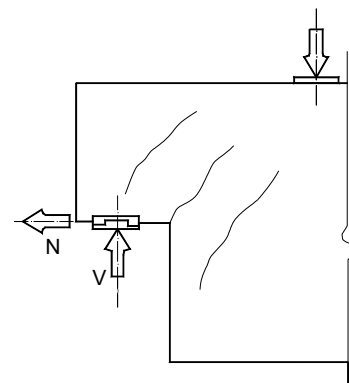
Patrón de fisuración típico en el extremo entallado de una viga bajo cargas de servicio
